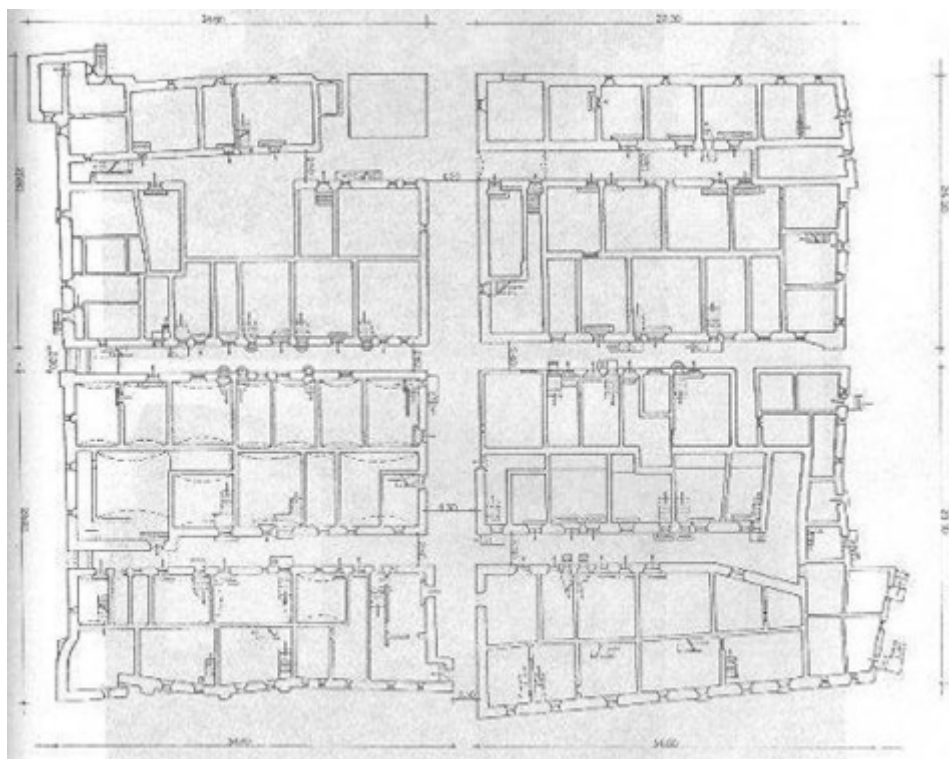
Planimetria del borgo fortificato di Castelnuovo.
